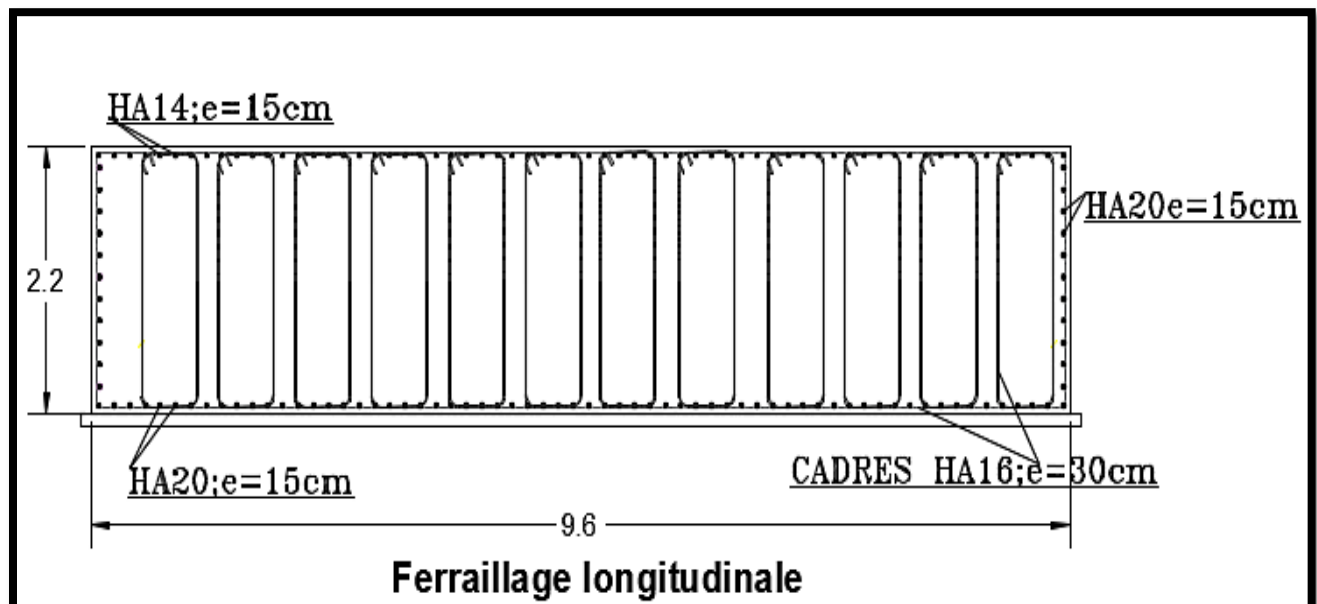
Ferrailage longitudinale de la semelle sous culée
